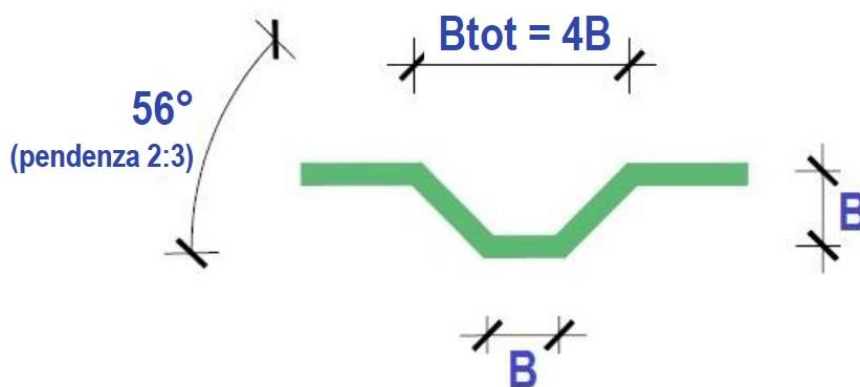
Sezione tipica dei fossi di guardia a sezione trapezia
